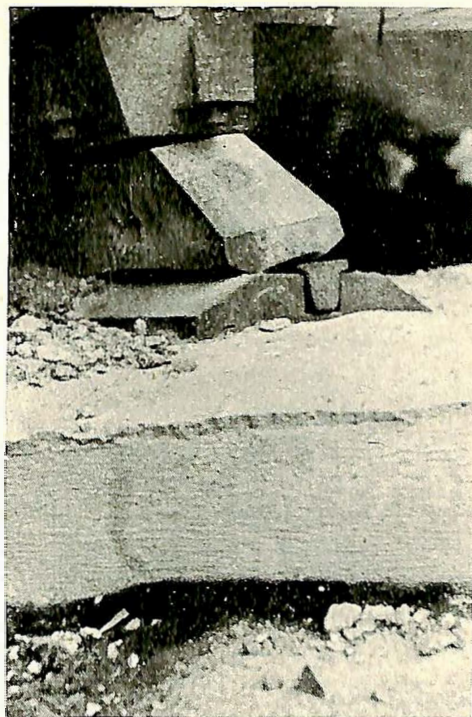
Bevegelig lager for en stor betongbjelkebru. Lagertappen er vridd av.
